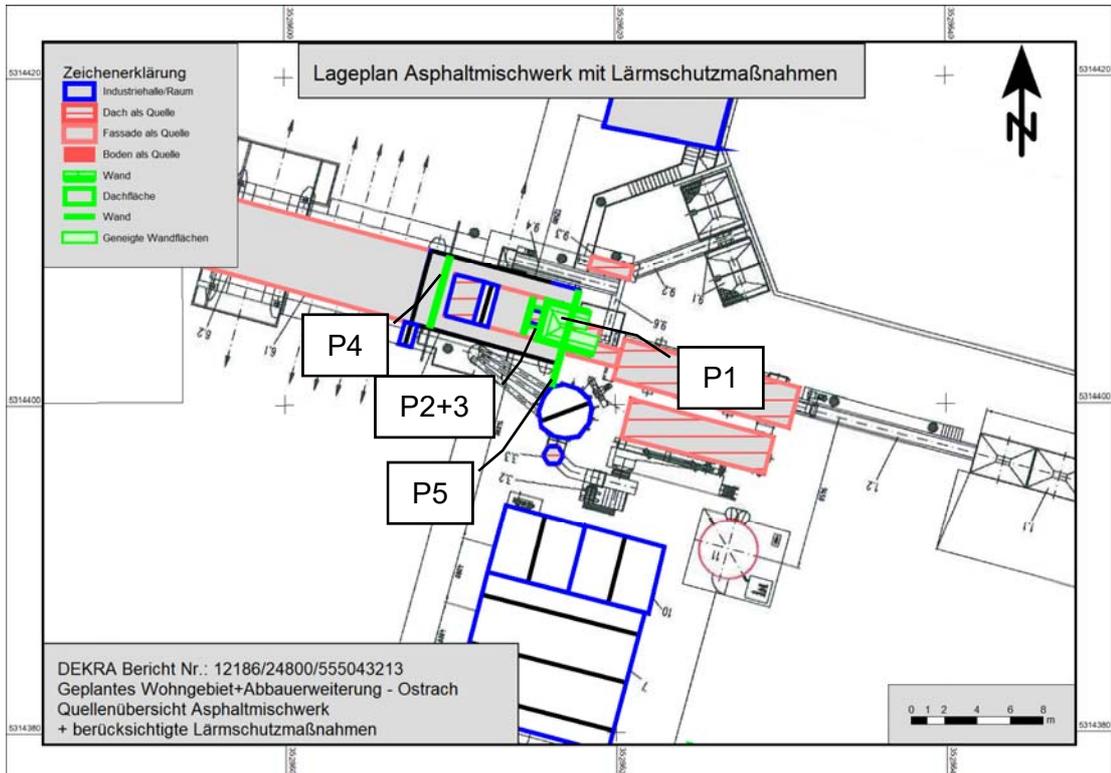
Lageplan Asphaltmischwerk mit Lärmschutzmaßnahmen
